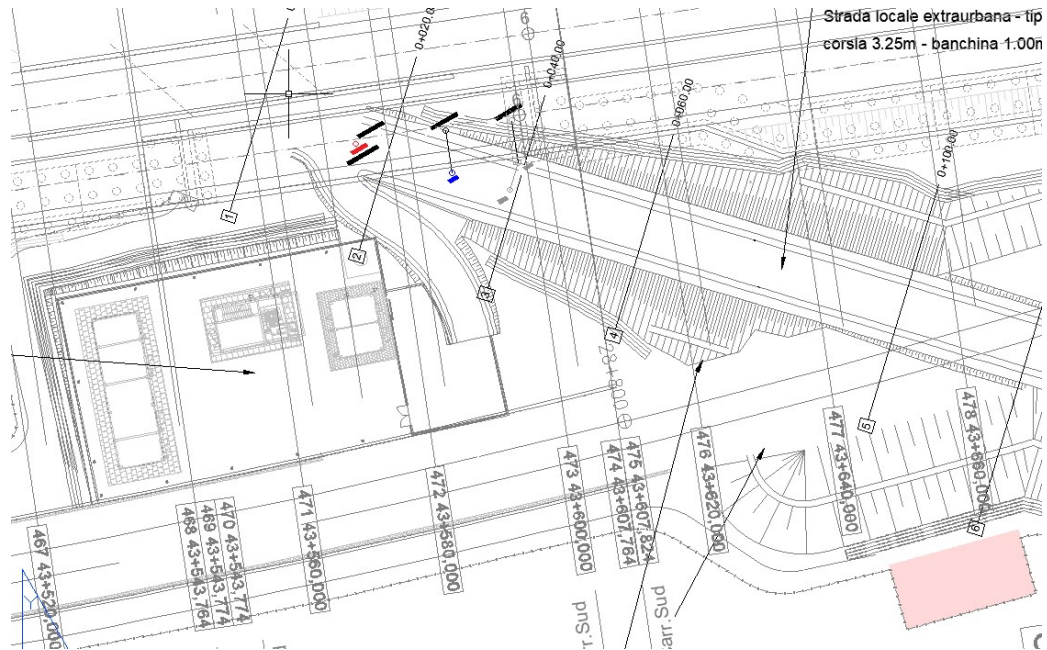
Stralcio planimetrico interferenza SS Telesina 2° sublotto Telese - S.Lorenzo
